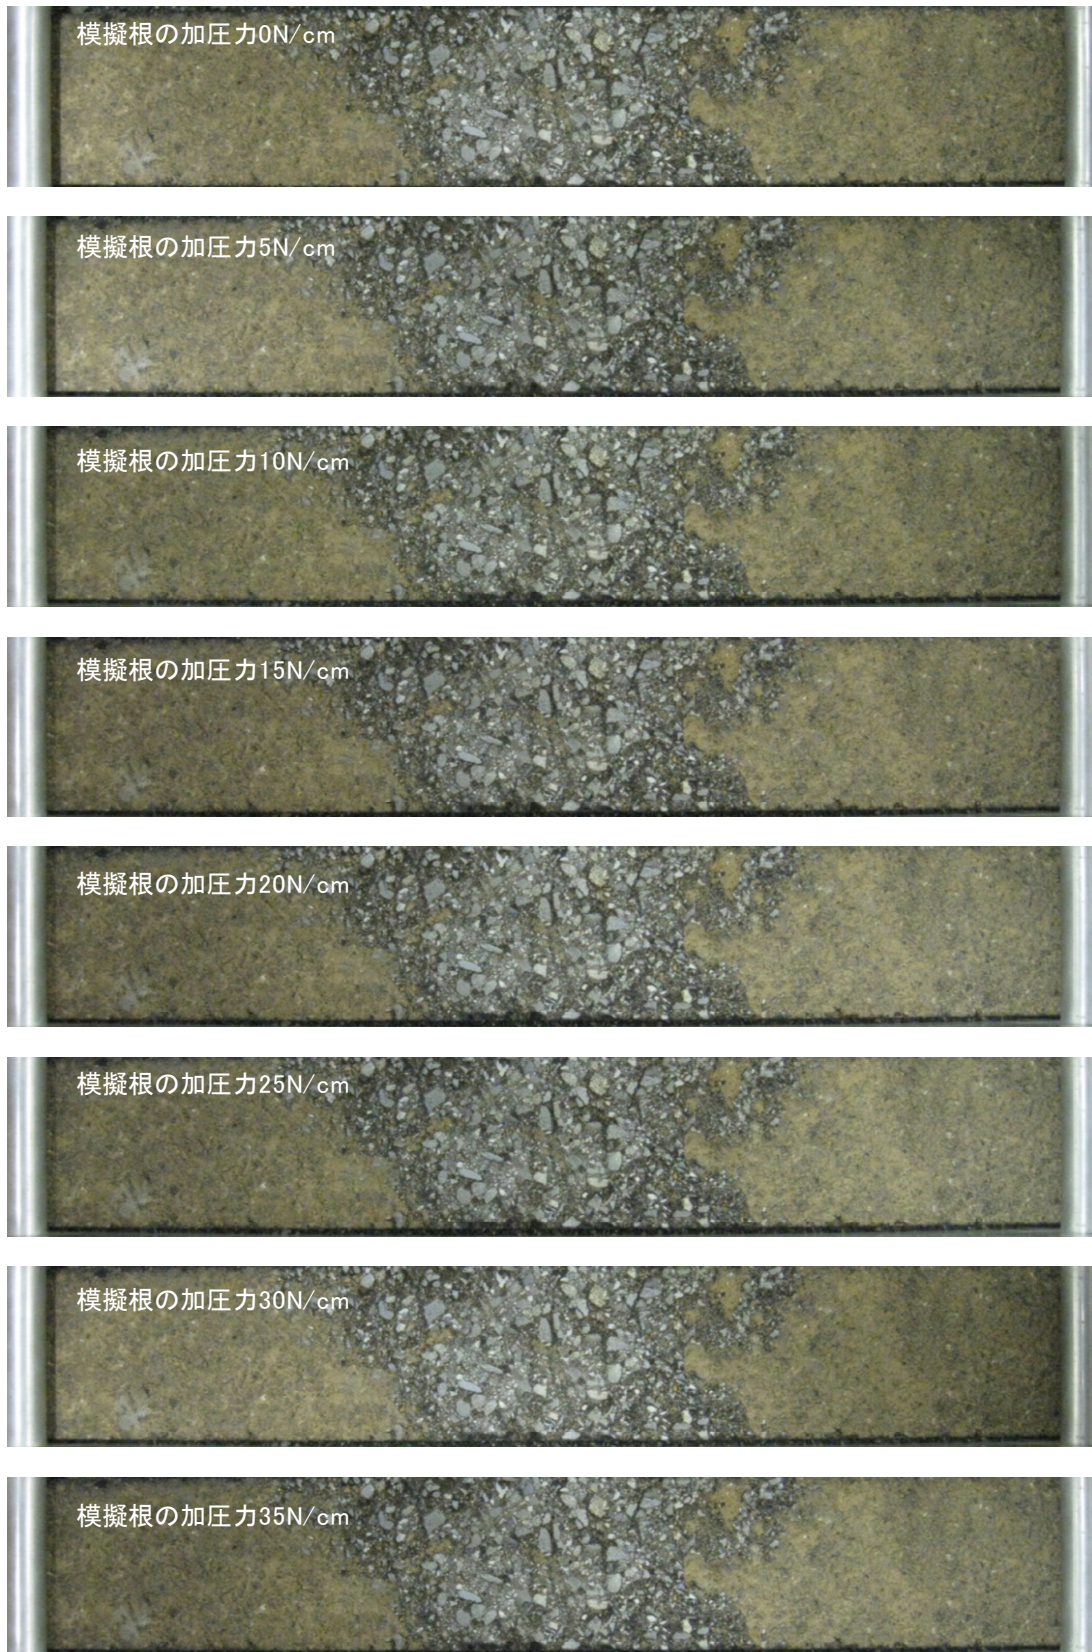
アスファルト舗装表面のひび割れ状態の一例(模擬根直上の砂層の厚さ10mm) 1/2
